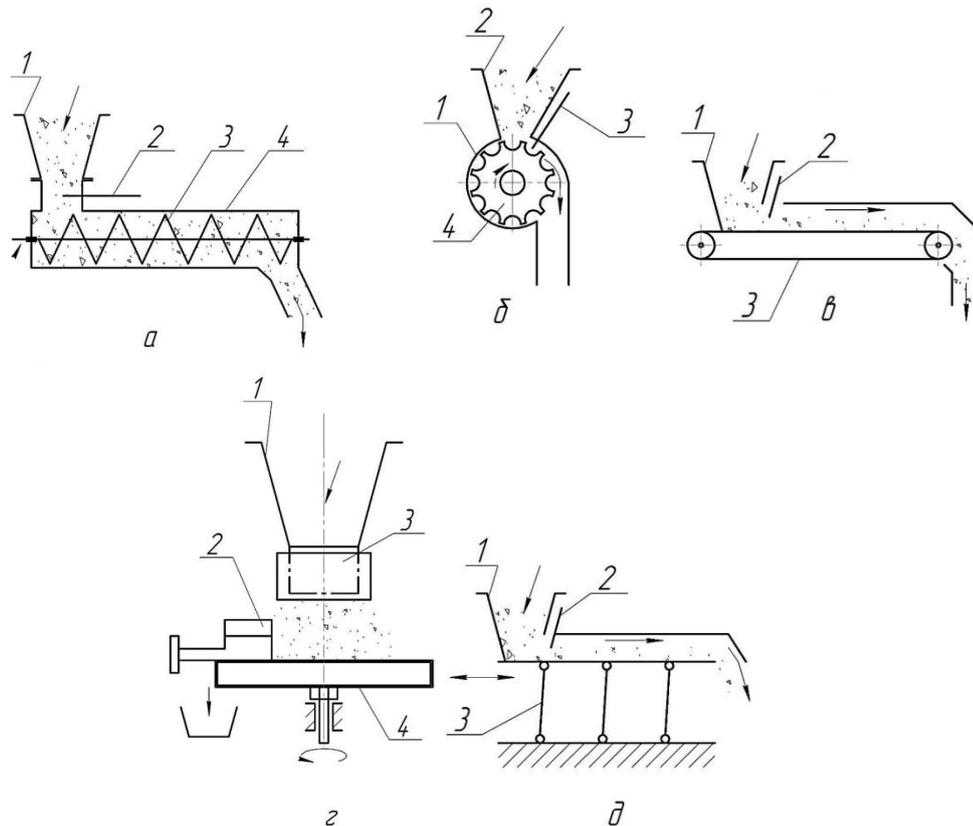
Технологические схемы дозаторов объемного типа для сыпучих компонентов: а – шнековый: 1 – бункер; 2 – дозирующая заслонка; 3 – винт; 4 – корпус; б – барабанный: 1 – корпус; 2 – бункер; 3 – дозирующая заслонка; 4 – барабан; в – ленточный: 1-й бункер; 2- дозирующая заслонка; 3-лента; г - тарельчатый: 1-бункер; 2- регулировочная заслонка; 3-регулирующая манжета; 4-тарелка; г – вибрационный: 1 – бункер; 2- регулировочная заслонка; 3- качающийся механизм
